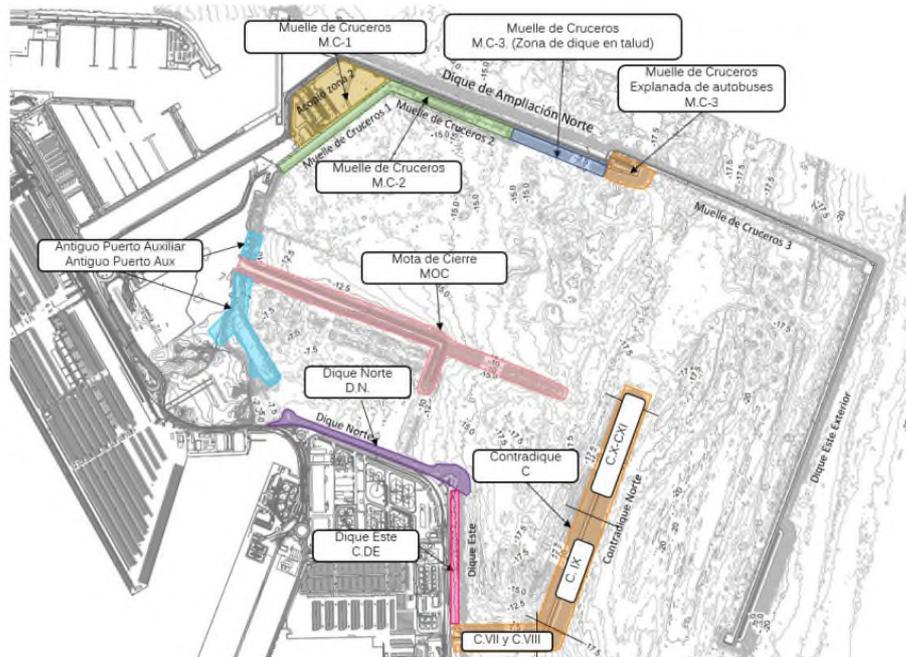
Vista en planta de las estructuras a desmontar. Fuente: Proyecto.
